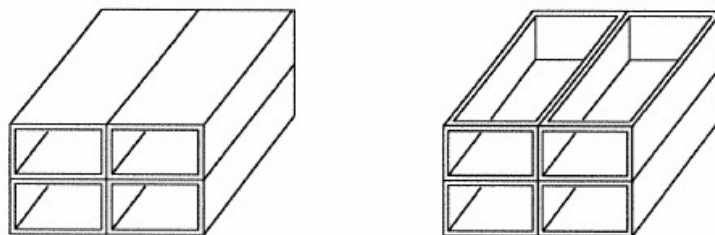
Sistema de células pré-fabricados (Acker, 2008)
